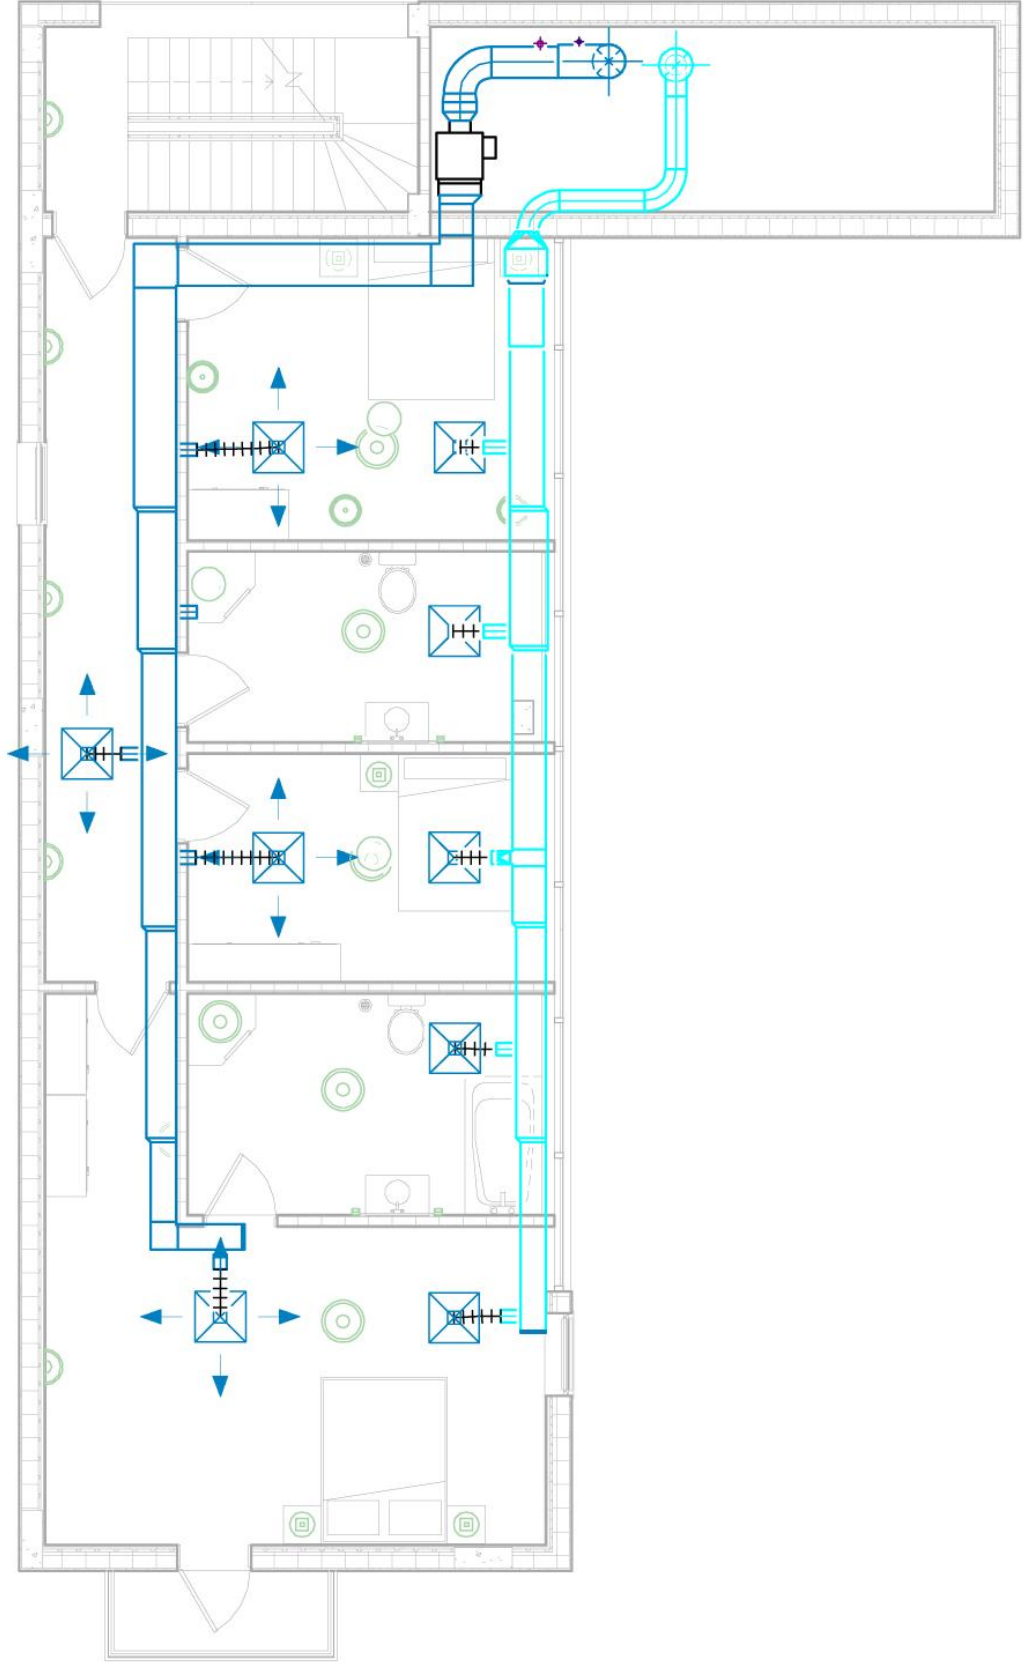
11. "G Villa Projesi" 1.Bodrum Kat Mekanik Projesi
